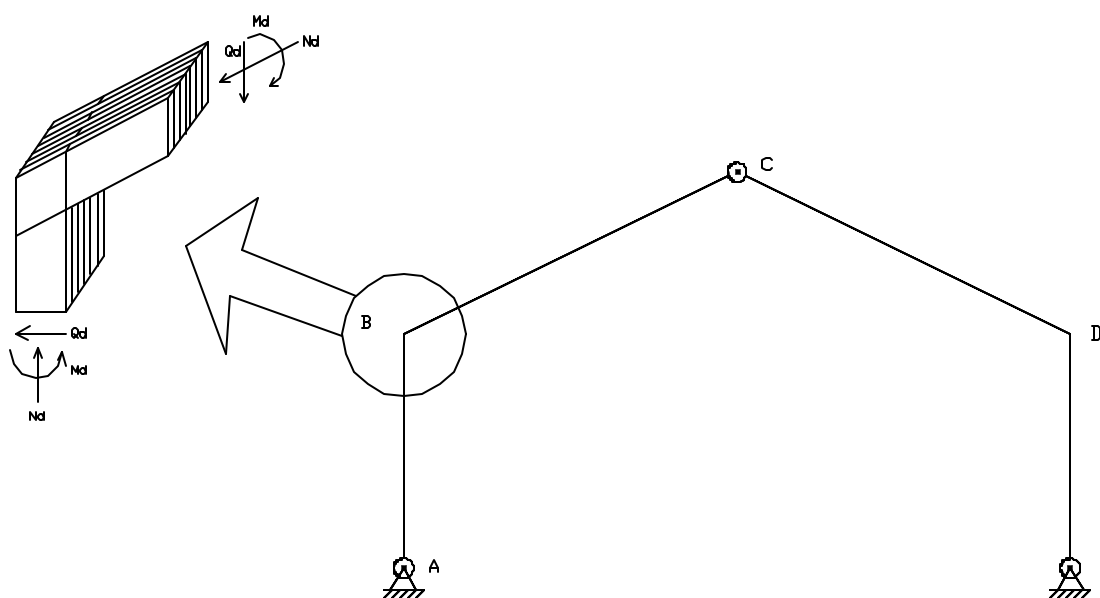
Pórtico triarticulado e detalhe de nó rígido feito multilaminar colado.
